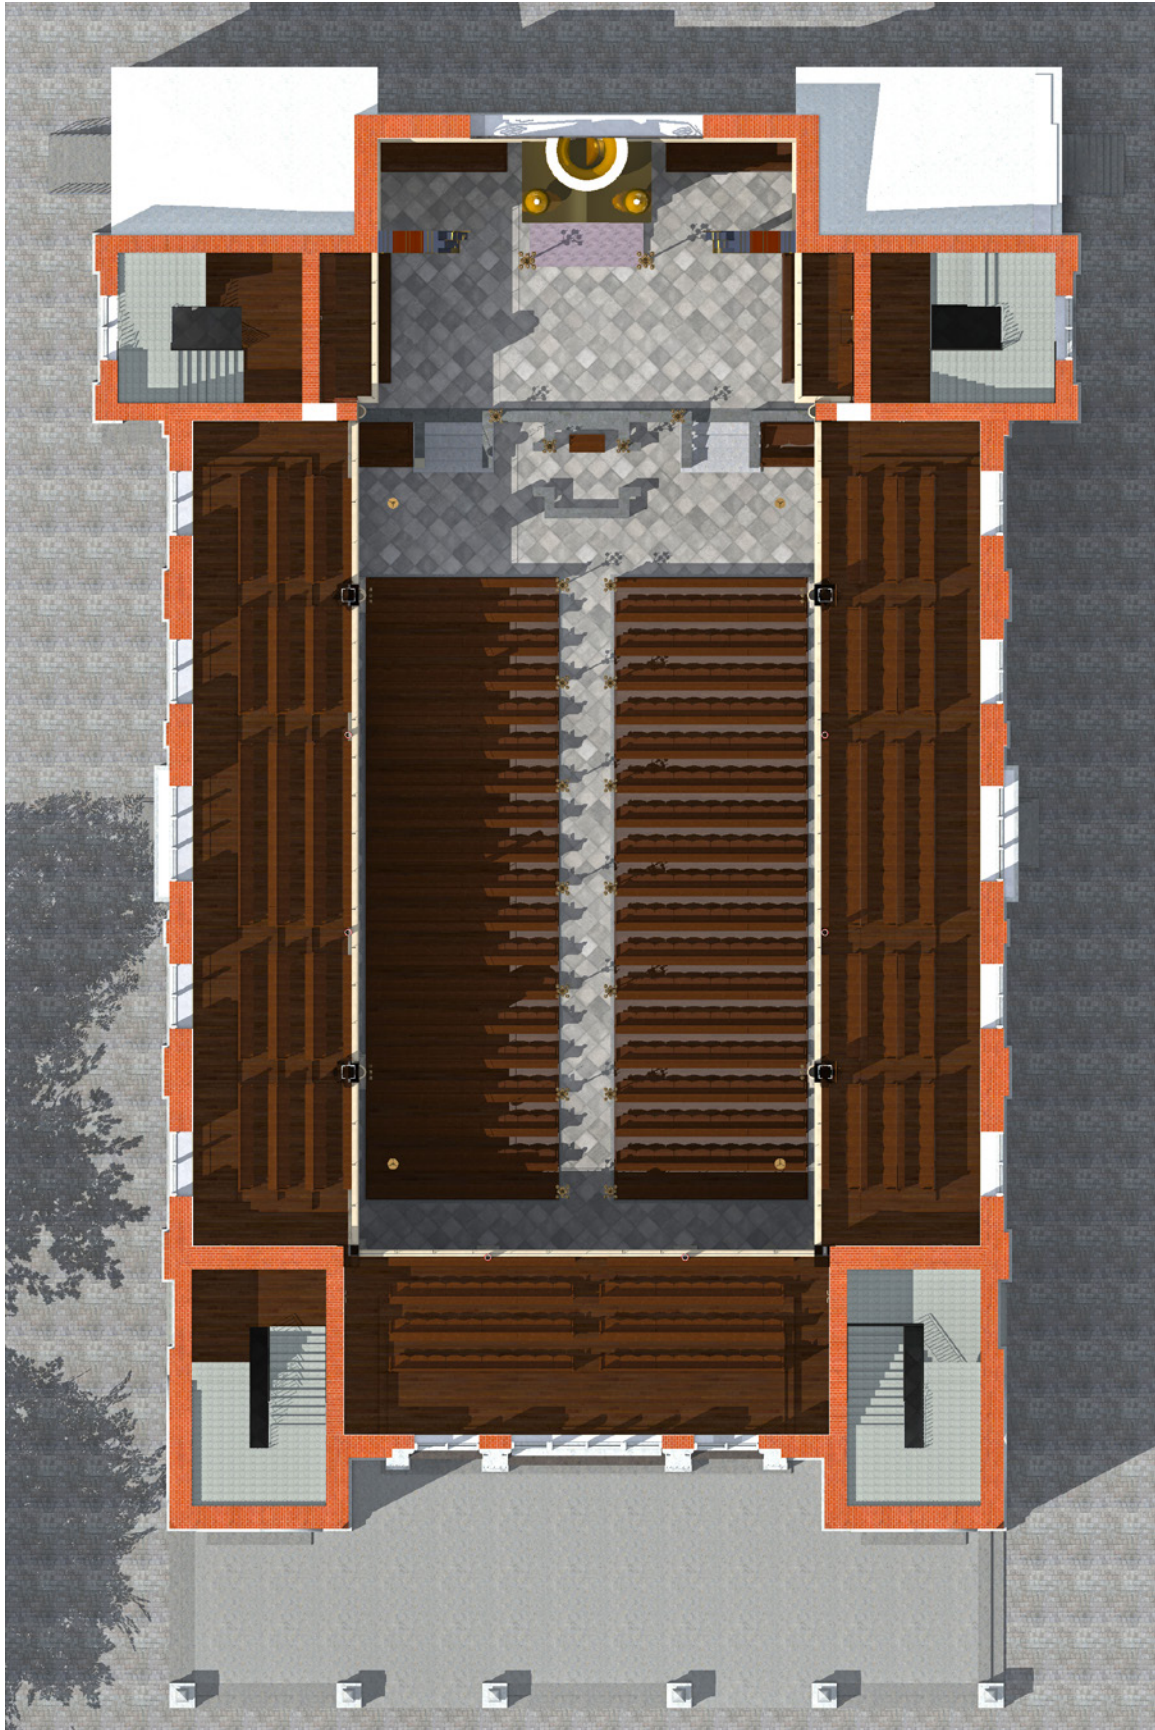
3D Grundriss - 1. Galerie
